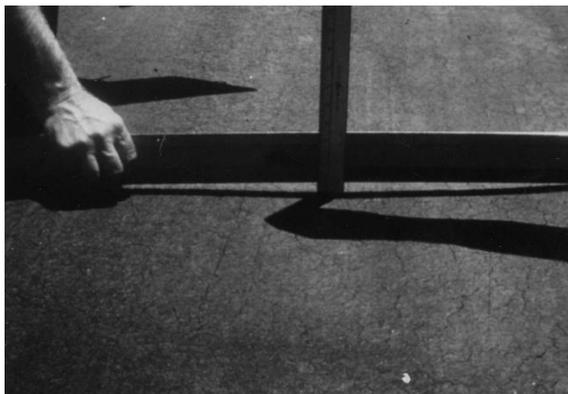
Ahuellamiento en el pavimento. Fuente Asphalt Institute
